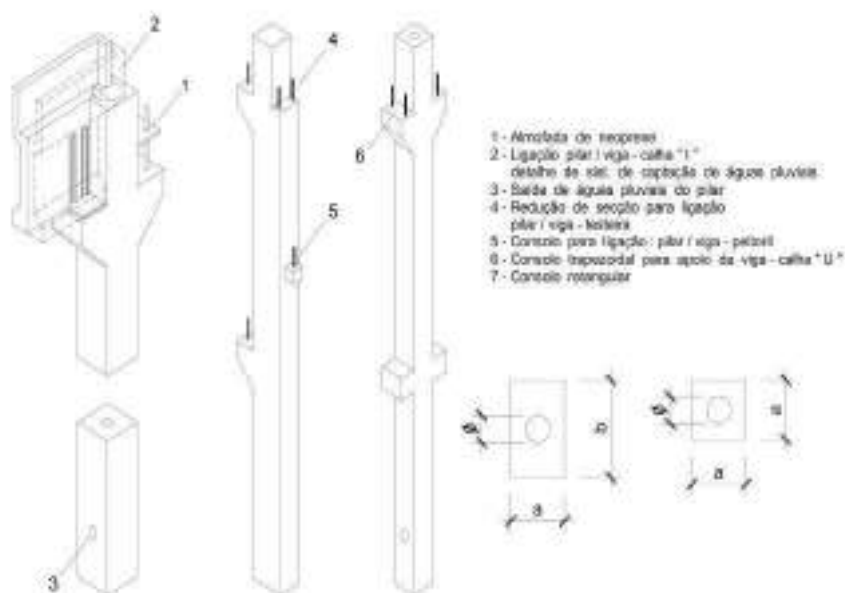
Características e elementos acessórios dos pilares de seção quadrada e retangular empregados no Brasil (Fonte: ABCIC apud El Debs, 2000)
